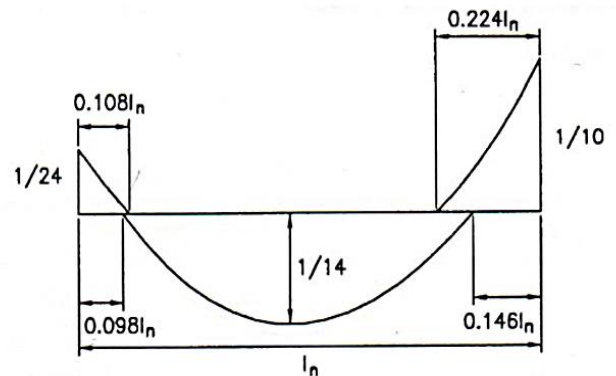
Corte del refuerzo en tramo exterior de elemento continuo con apoyo exterior solidario provisto por viga
